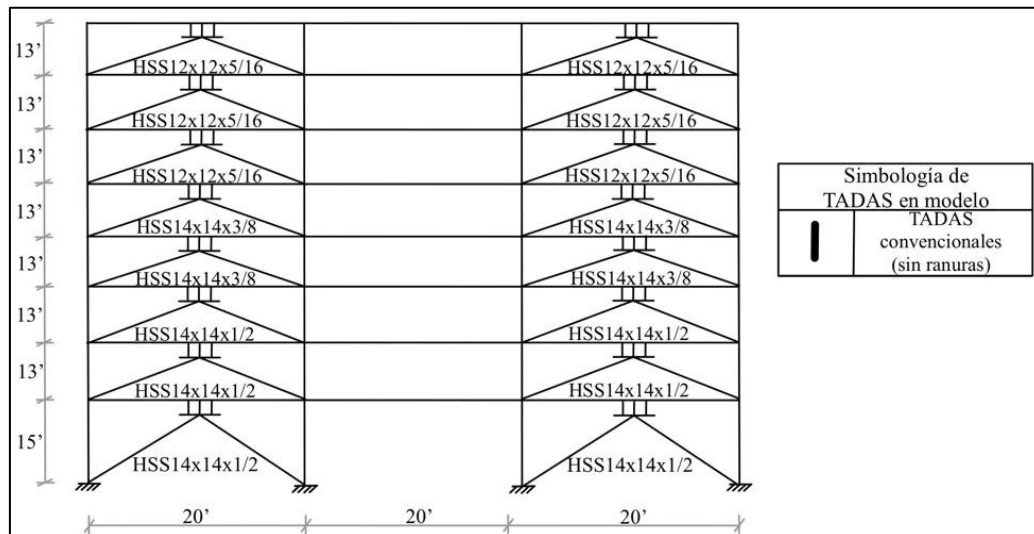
Vista en Elevación del Arquetipo 2 con contraviento Chevrón y TADAS convencionales.
